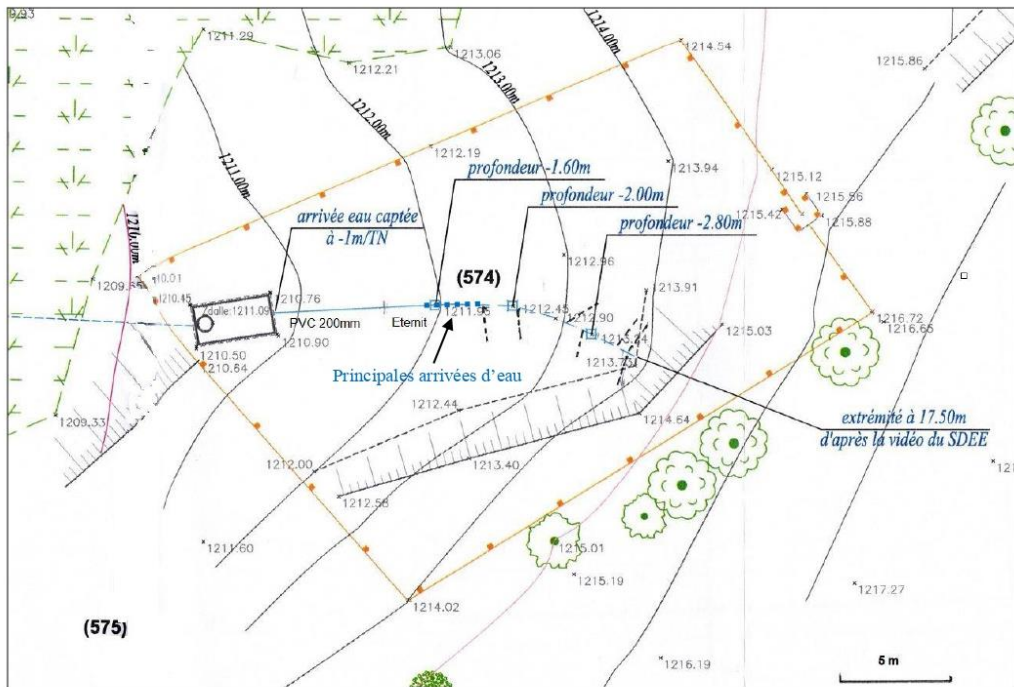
Plan de masse du captage « Amourettes Aval » avec localisation des canalisations PVC et Eternit et des drains (cf. inspection vidéo-caméra du 20/09/2020 par SDEE)
